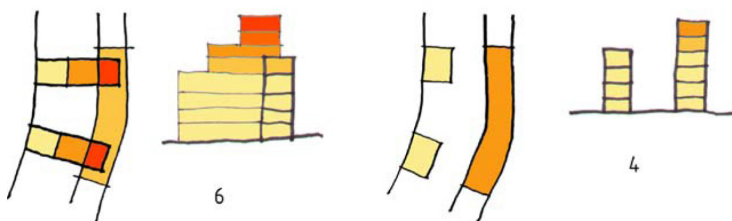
viser to av de vurderte alternativene for å øke utnyttelsen uten å øke bygningshøyden mot gate. Til venstre ses bakfløyer i plan og snitt. Til høyre punktbebyggelse i gårdsrommet. Alternativet med bakfløyer ble anbefalt mens punktbebyggelsen ble frarådet (LPO 2005b:14).
